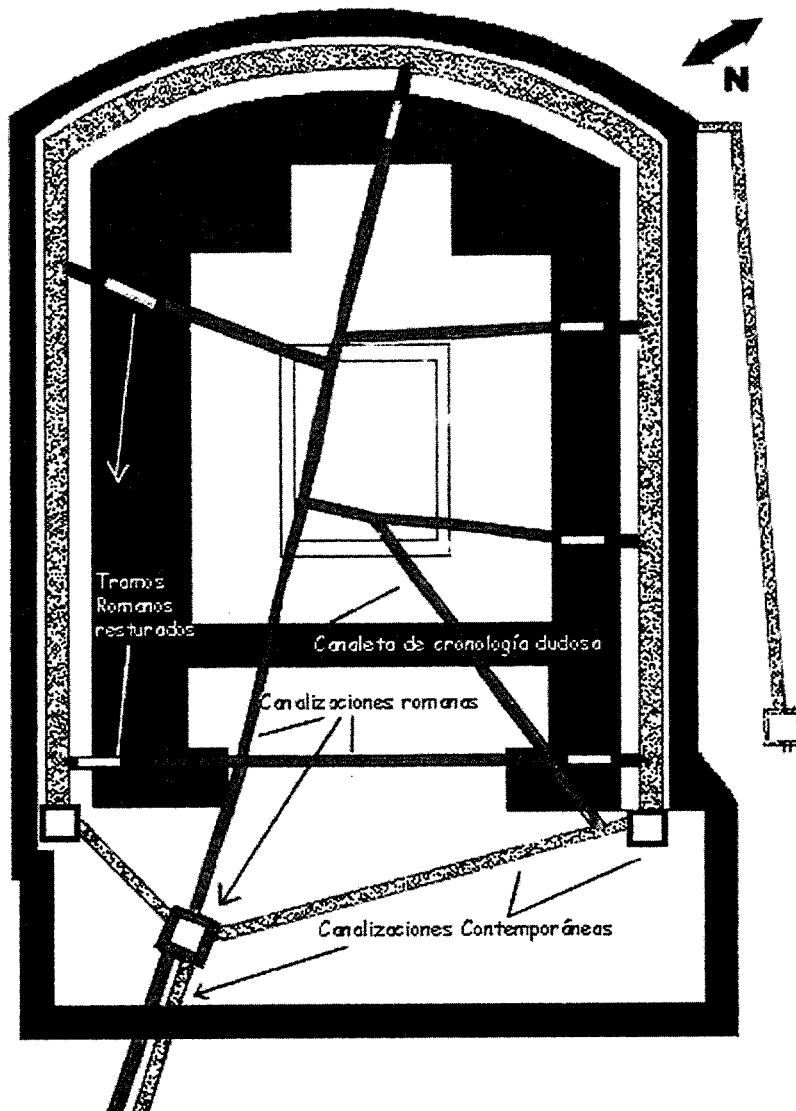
Plano recogido en el Proyecto de Ejecución de 1990 de los arquitectos Gallego Jorroto y César Portela y titulado «Restauración de Santa Eulalia de Bóveda». Este plano procede del proyecto de González Trigo para la restauración del edificio en la década de 1970. Nuestra aportación ha consistido en redibujar nuevamente toda la planta del edificio y señalar, mediante tramas de diferentes colores, aquellas canaletas que suponemos romanas (en gris), aquellas que creemos fueron obra del arquitecto arriba mencionado (trama punteada de negro sobre blanco), y aquellos tramos que creemos romanos pero que han sido retocados por las obras de la década de los 70 (color negro con rectángulo en blanco). Fuente: Planimetría depositada, junto al proyecto de ejecución, en el Servicio de Arquitectura de la Dirección Xeral de Patrimonio.
